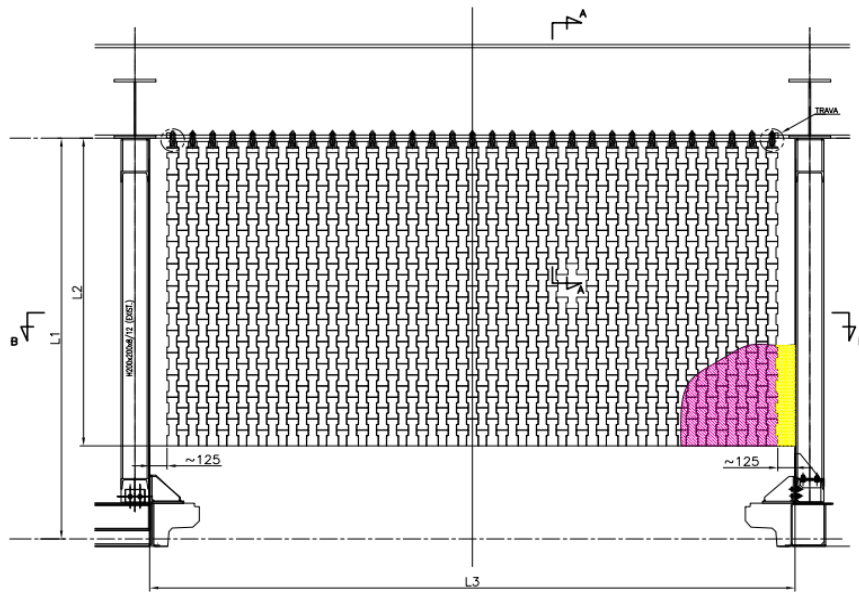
Detalhe da fixação da parede divisória tipo cortina.
